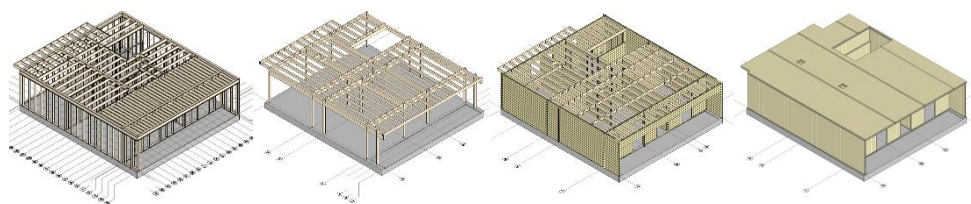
Estrutura do primeiro piso dos quatro sistemas construtivos (Desenhos do autor).
